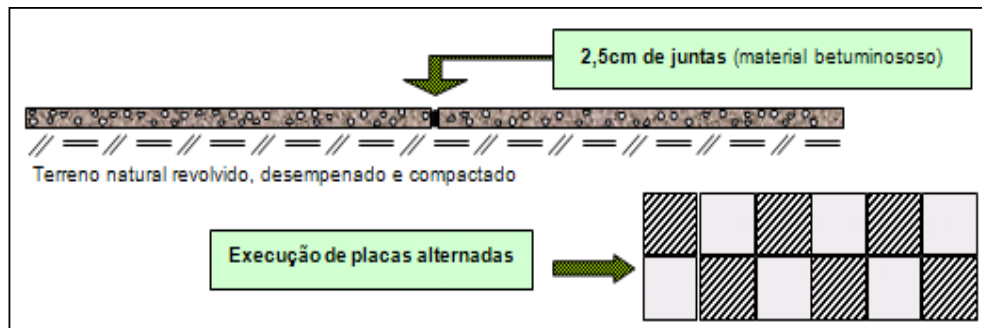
Pavimento à Base de Concreto (GEIPOT, 2001)
